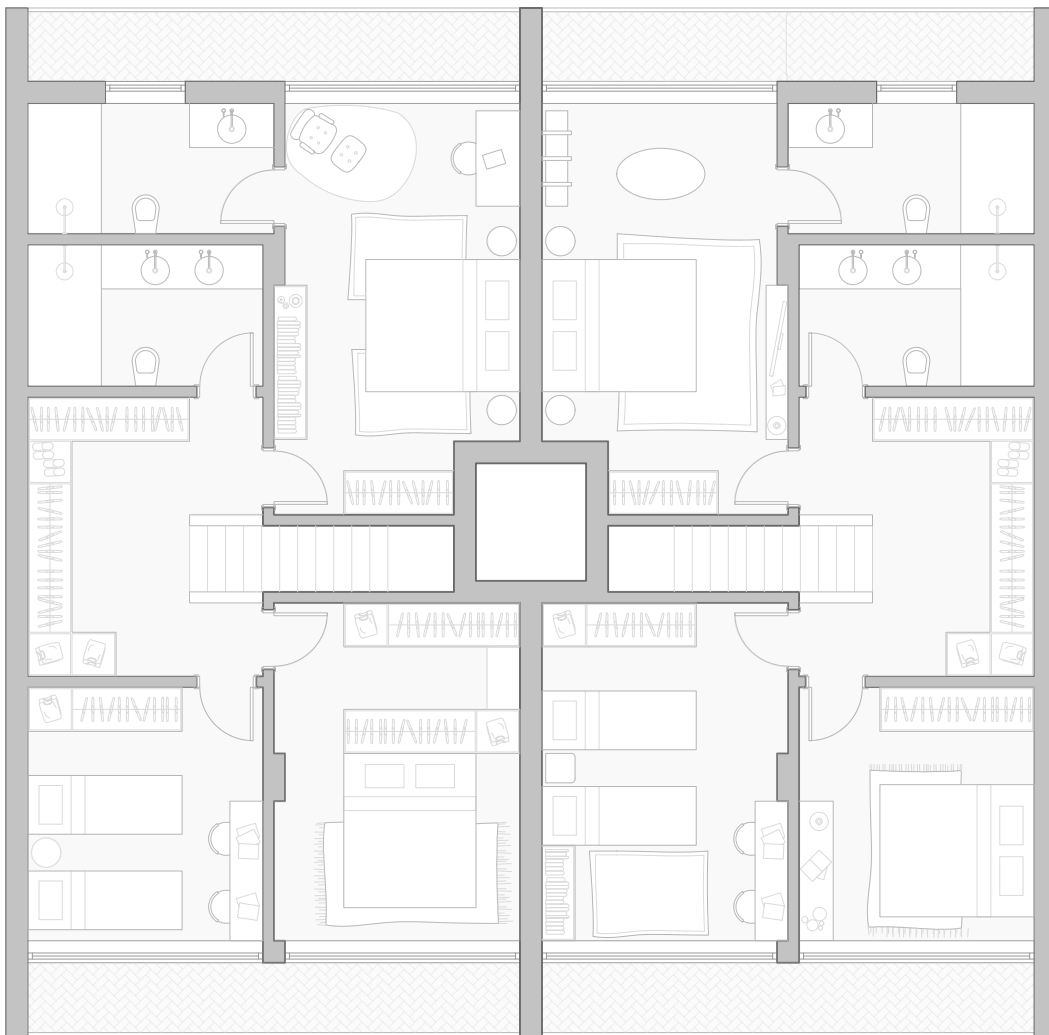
Planta T3 2x2 Piso Superior 1:100
